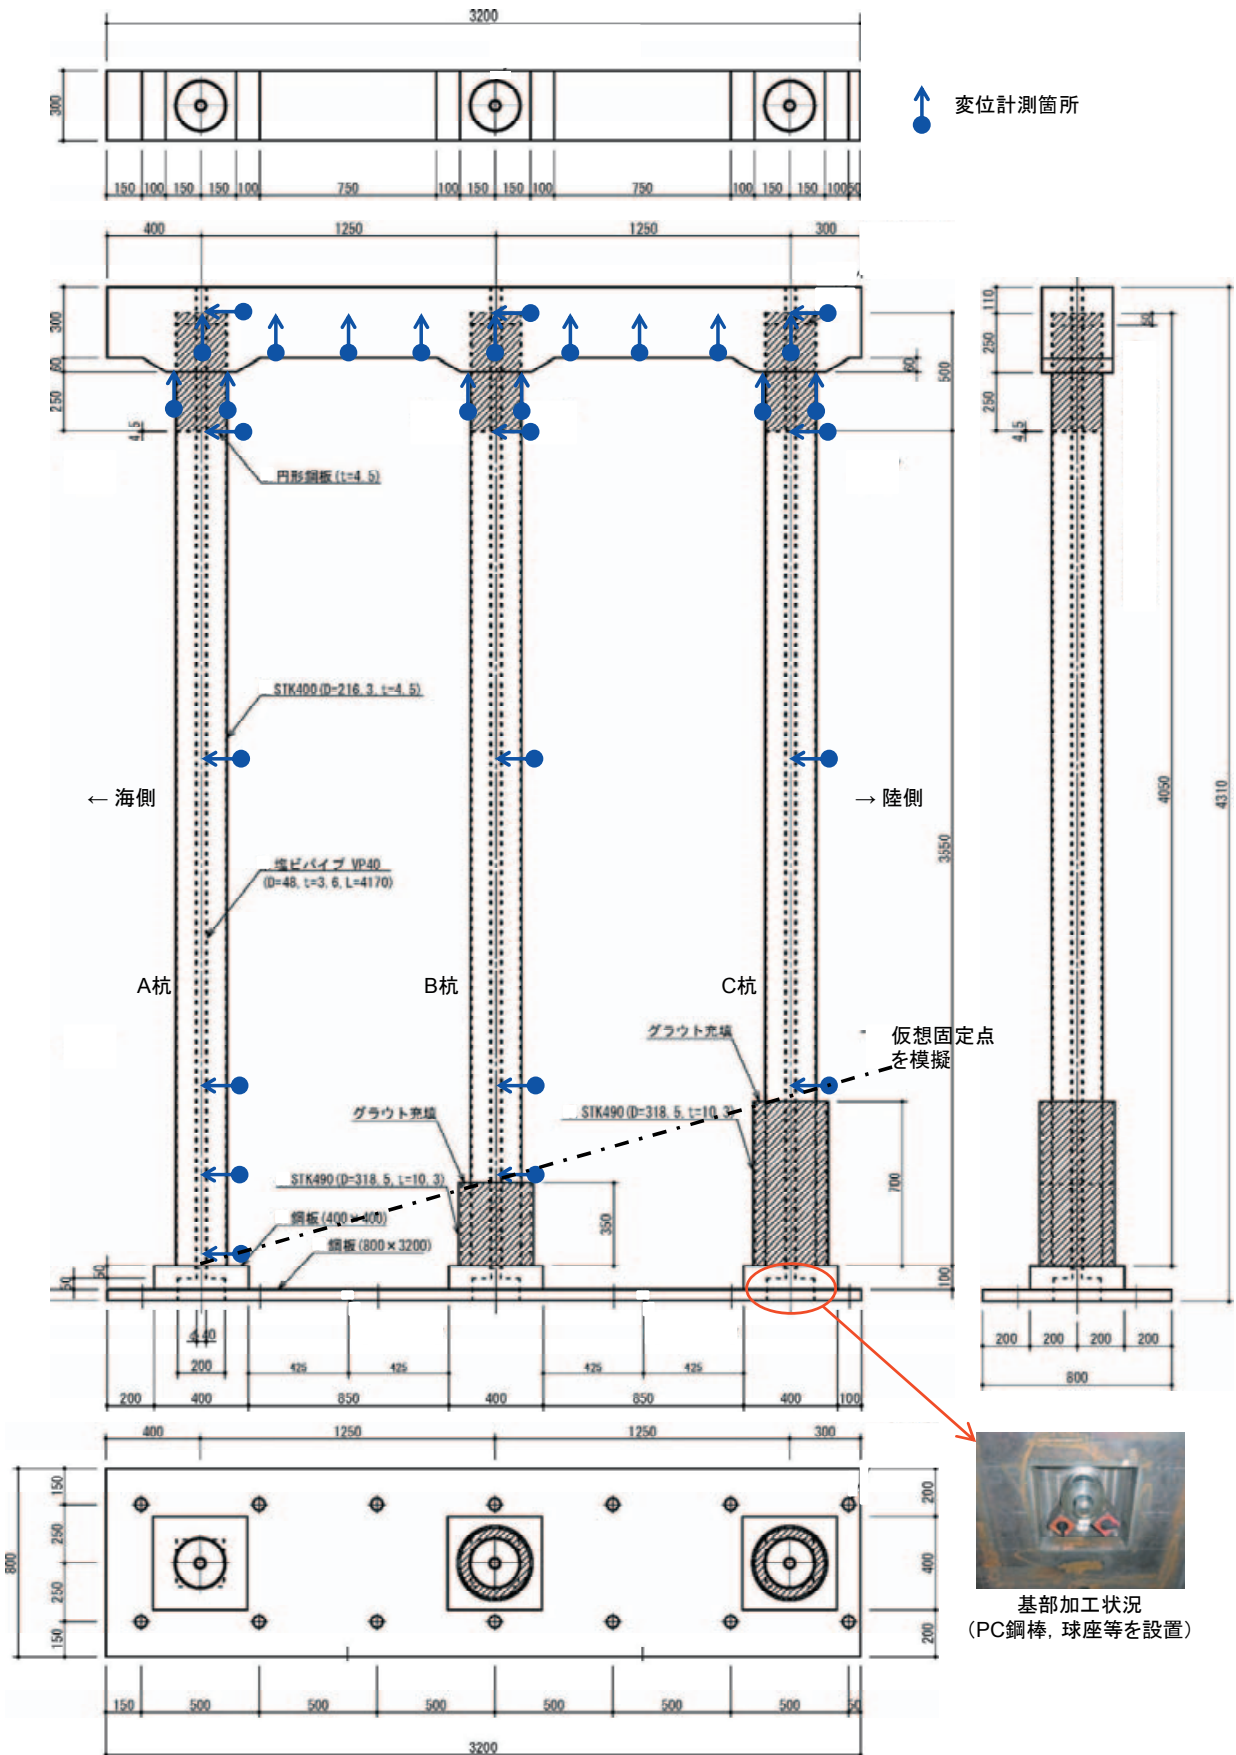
試験体の形状・寸法および変位計測箇所 (単位: mm)
